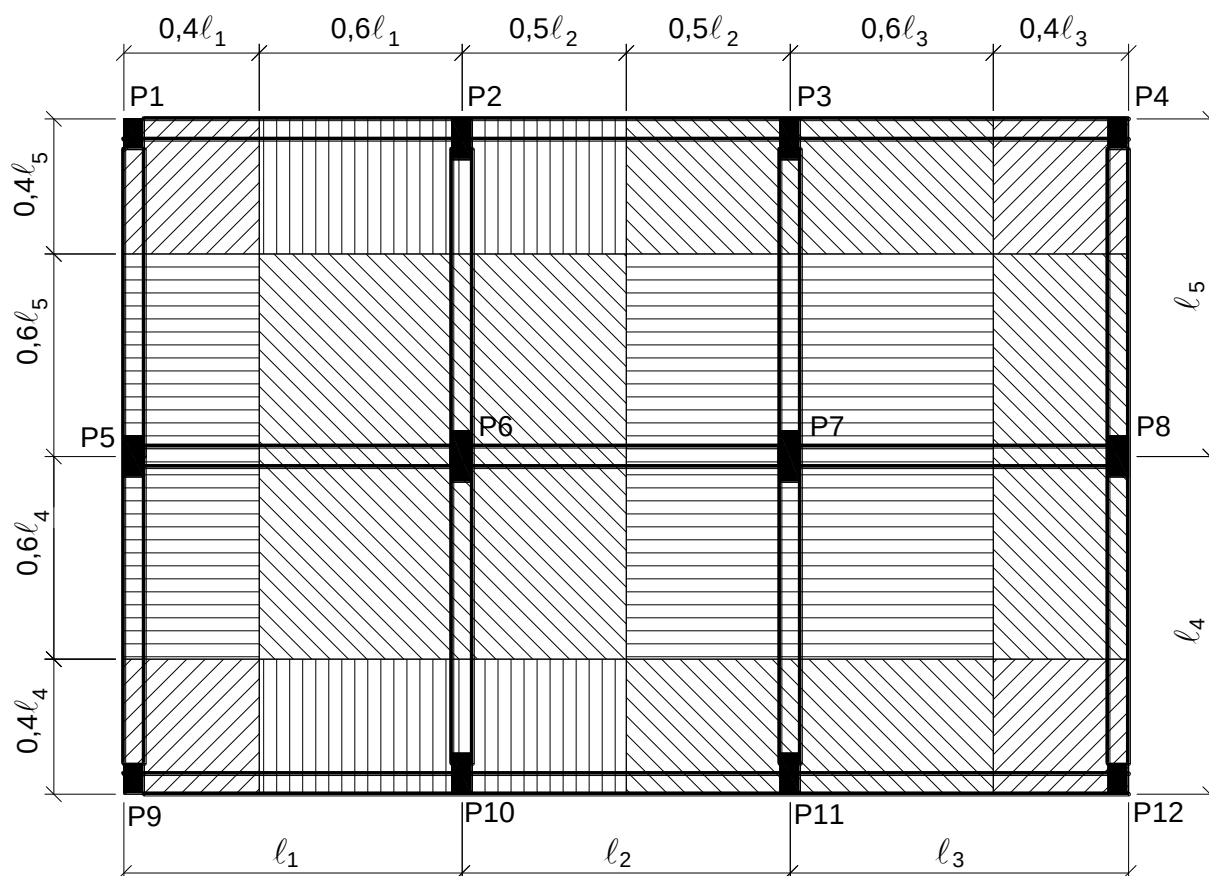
Processo simplificado para determinação da área de influência dos pilares.
